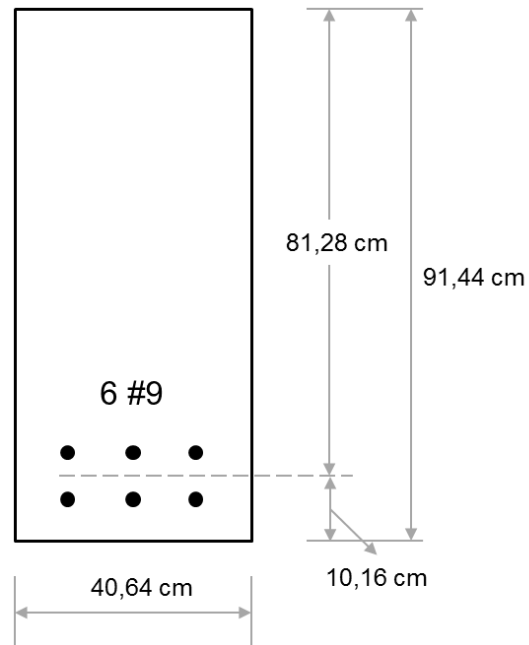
Características y dimensiones de la sección transversal de la Viga 2. Fuente: McCormac y Brown, 2011.
